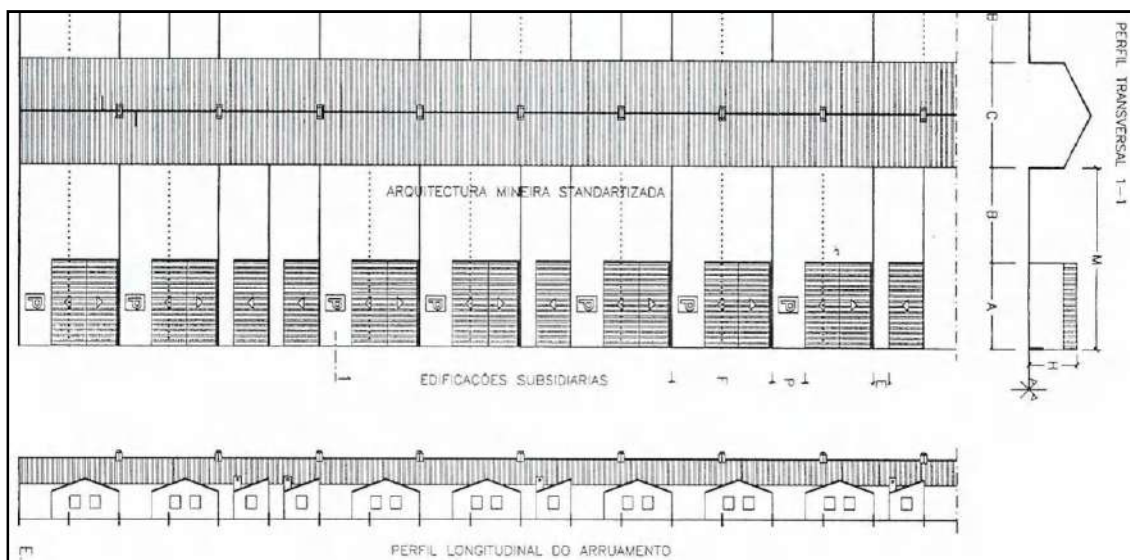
Loteamento integrando as habitações mineiras em banda e o novo edificado subsidiário proposto. A delimitação dos lotes suprime a rua pré-existente. (Proposta de Plano de Pormenor, Arq. CM)
